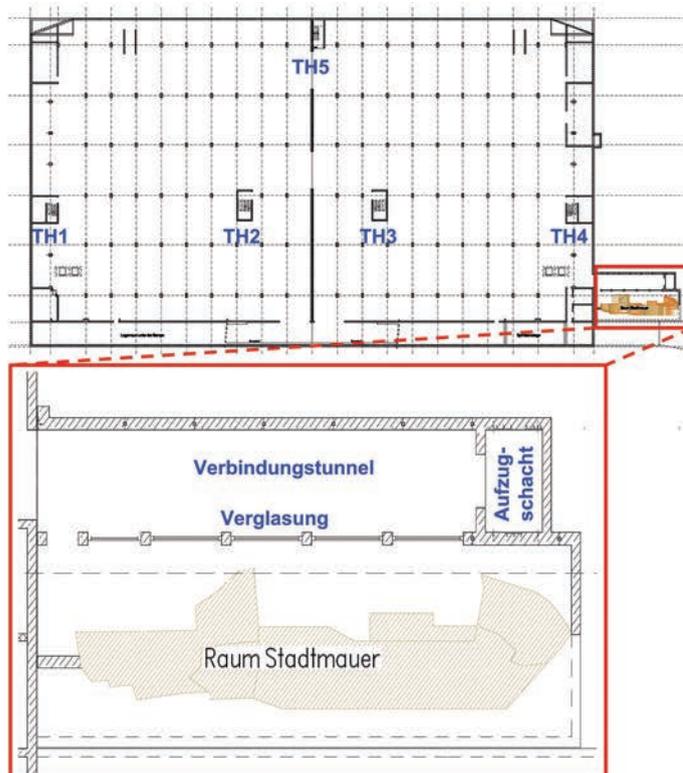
Grundriss der Tiefgarage 2. UG mit Detail des Verbindungstunnels sowie Lage des Universitätsgebäudes
